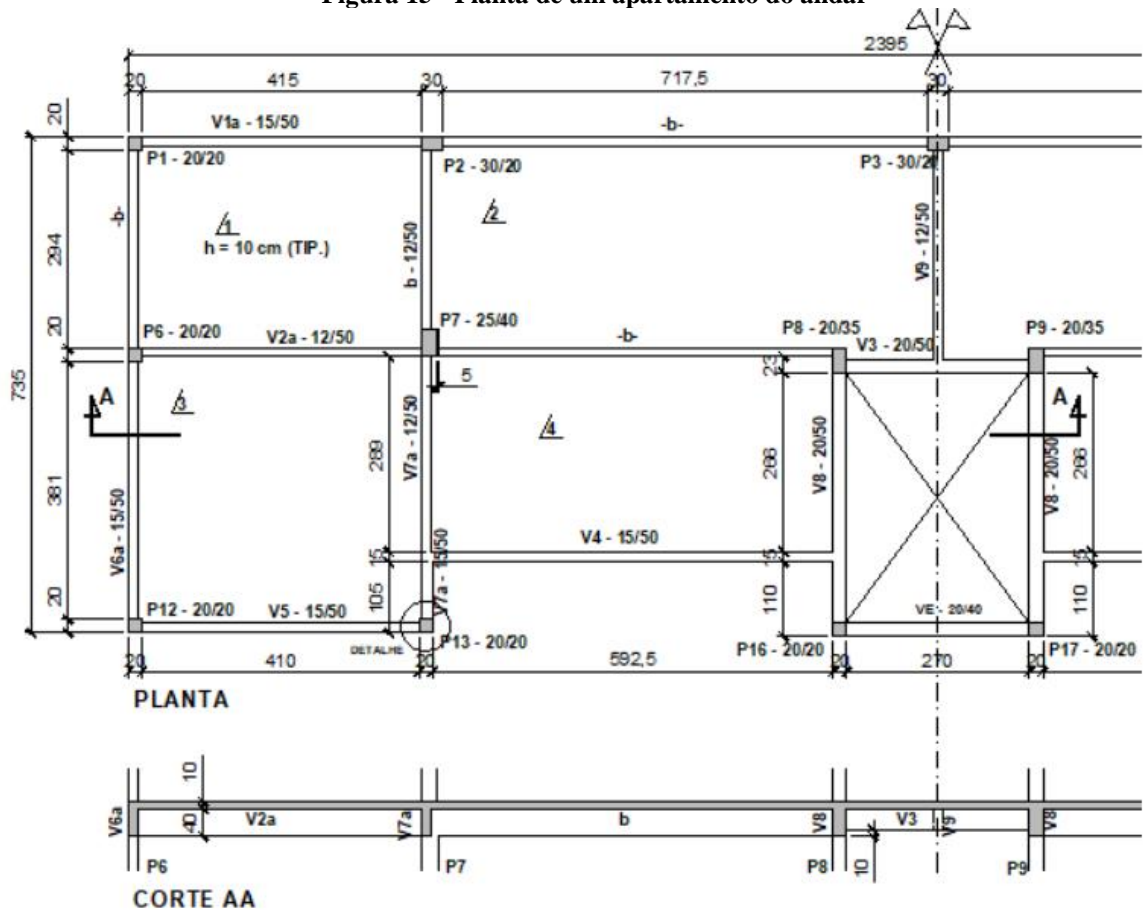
Fôrma do pavimento tipo - Planta e corte
